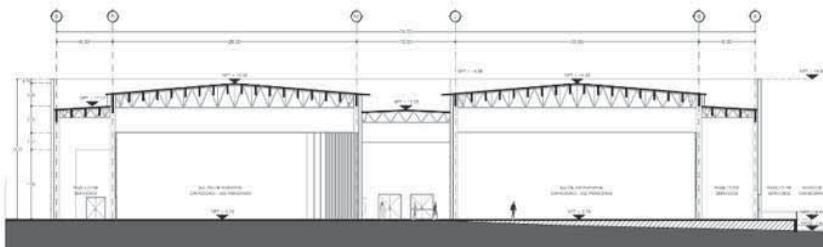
Sección estructural edificio A, salones de usos múltiples. Elaboración propia.
